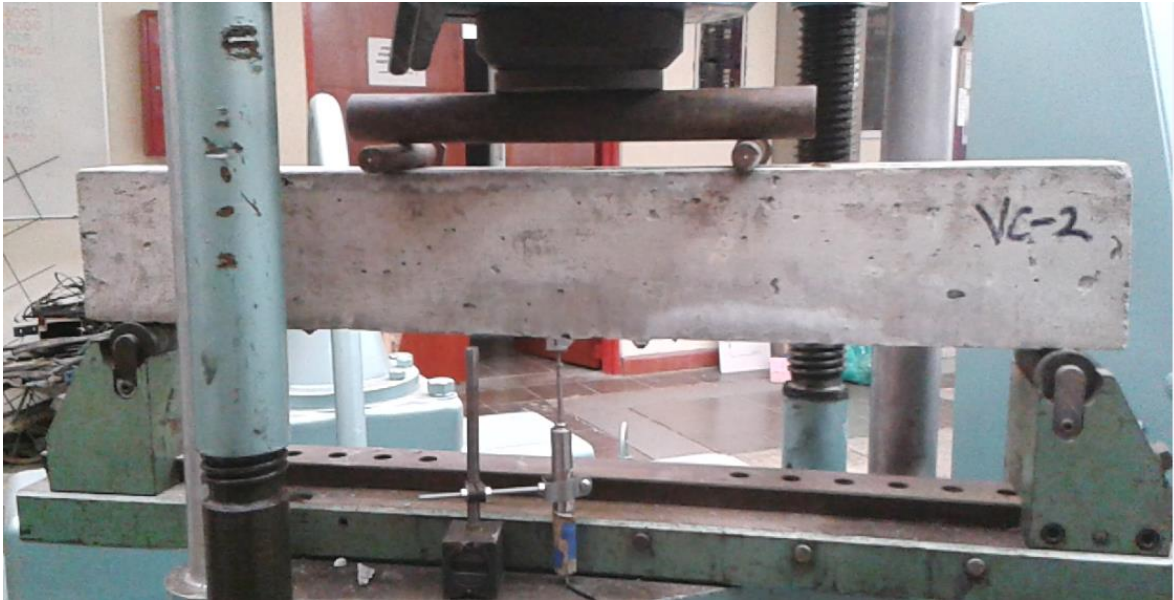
Viga VC-2 al Inicio de la prueba
